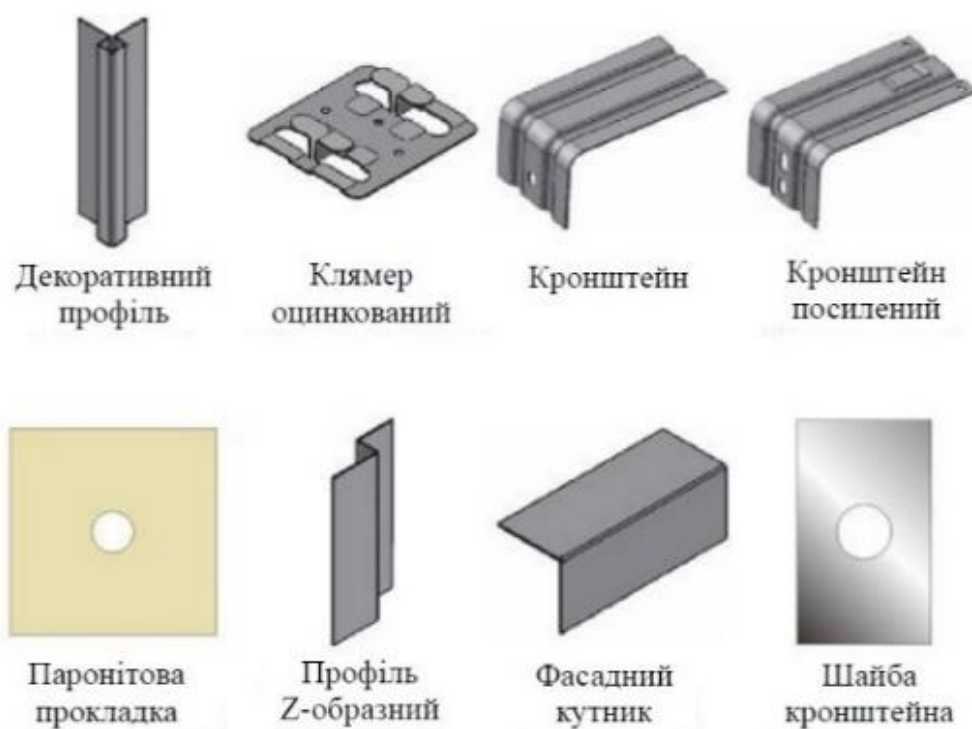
Кріплення для монтажу вентильованого фасаду
